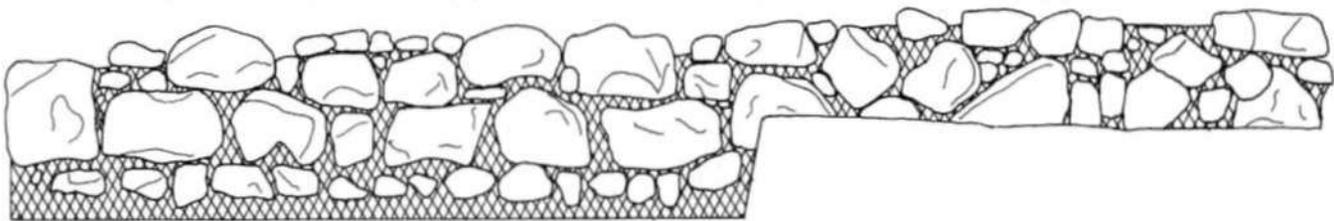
Espacio LII. Muro oeste. (Primera Fase).
